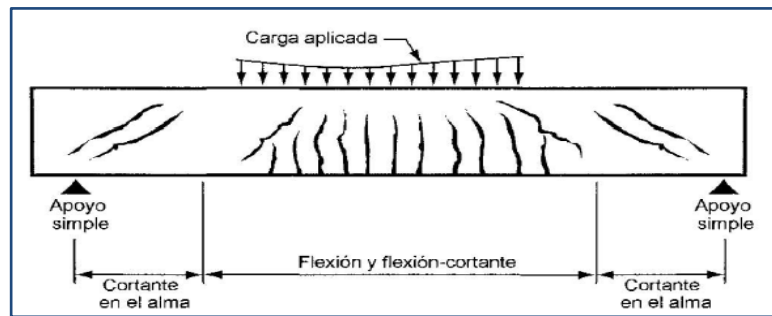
Fisuración típica en vigas sometidas a flexión compuesta, de Rodriguez, (2011), Tesis de grado.
